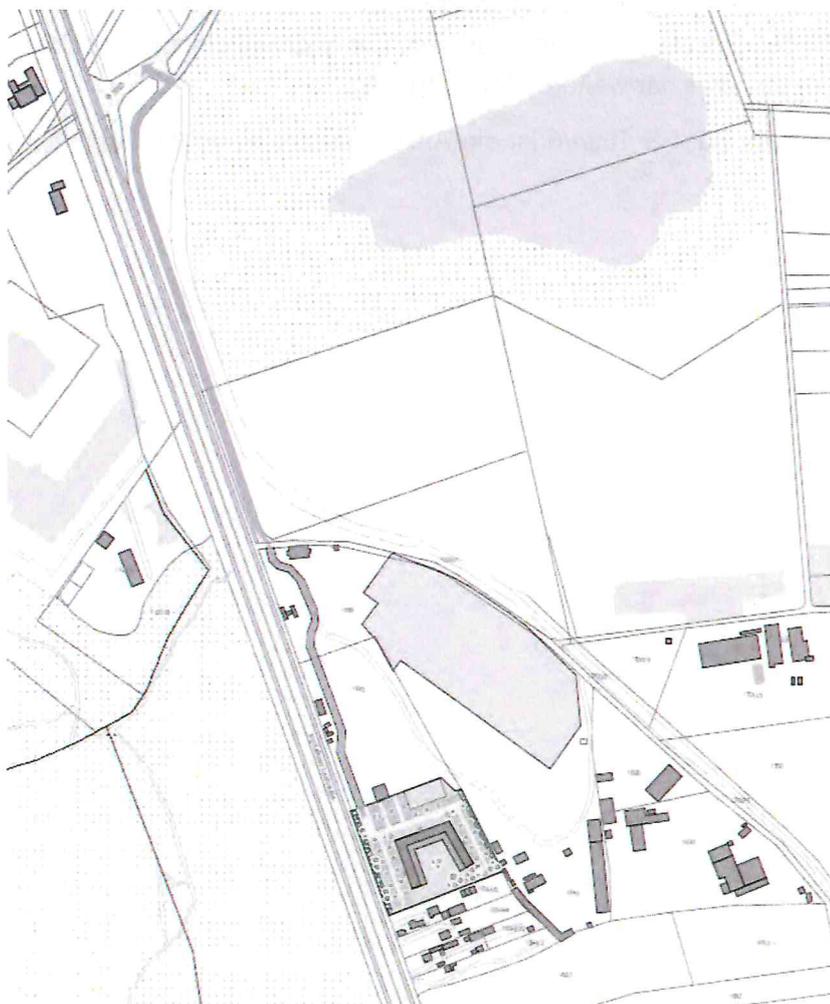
Lageplan Geltungsbereich mit Zuwegung / Anbindung an nächste öffentliche Verkehrsfläche; siehe auch Anlage 2.4 (Quelle: Lang Hugger Rampp GmbH | Architekten)
